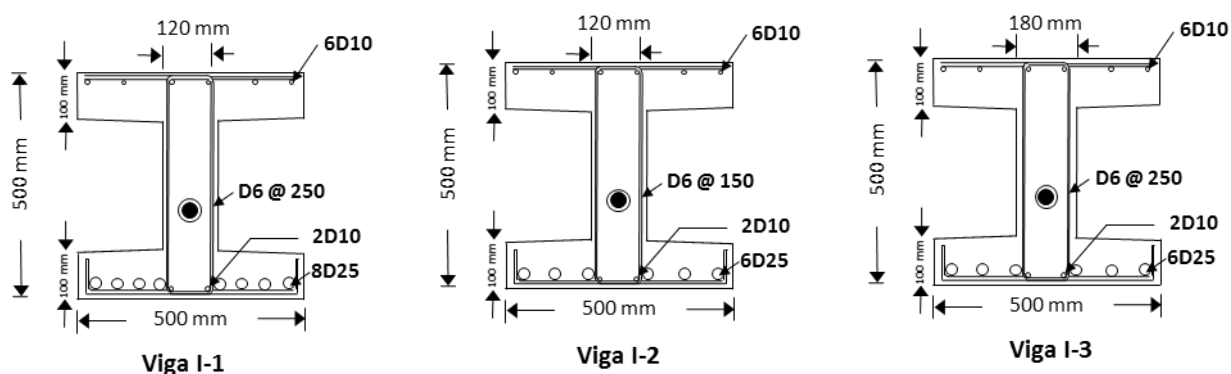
Secciones transversales, dimensiones y detalles de las vigas de HPP.
